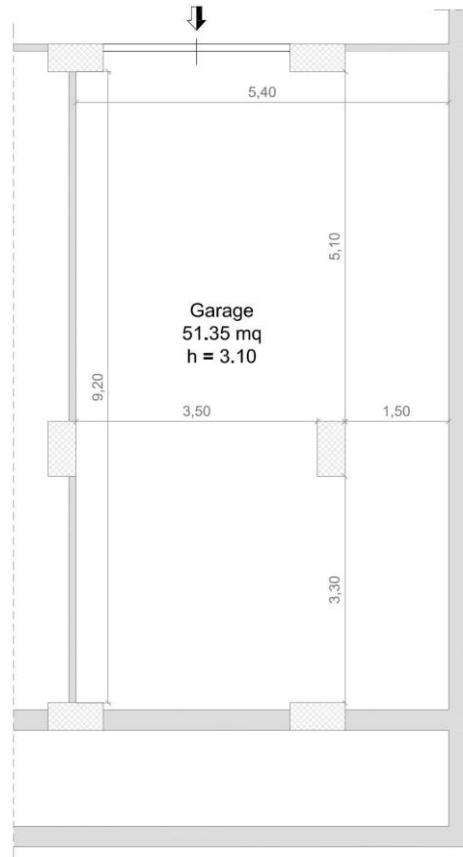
Planimetria Stato di Fatto Foglio 30, p.lla 2169, sub 27.
